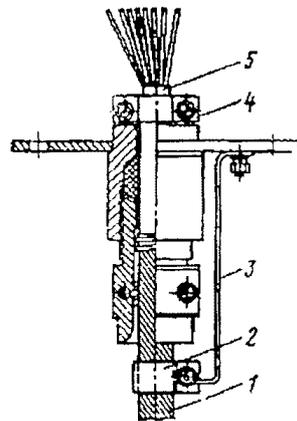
Схема заземления контрольного кабеля со свинцовой оболочкой:
